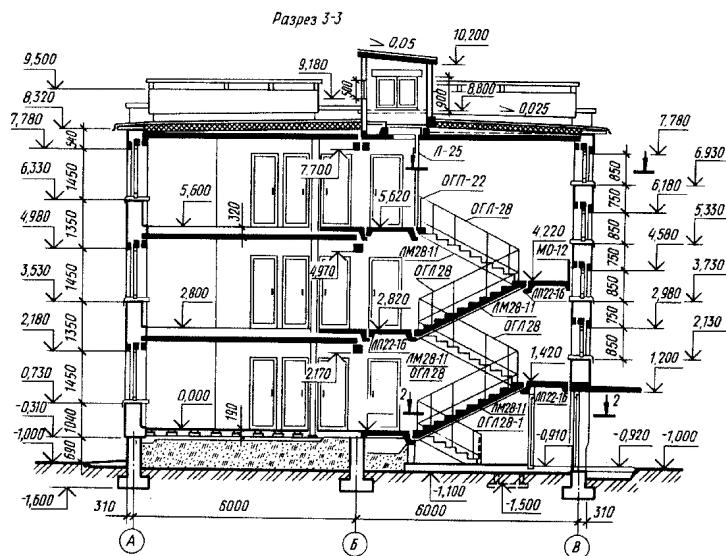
Конструктивный разрез жилого дома по лестничной клетке
